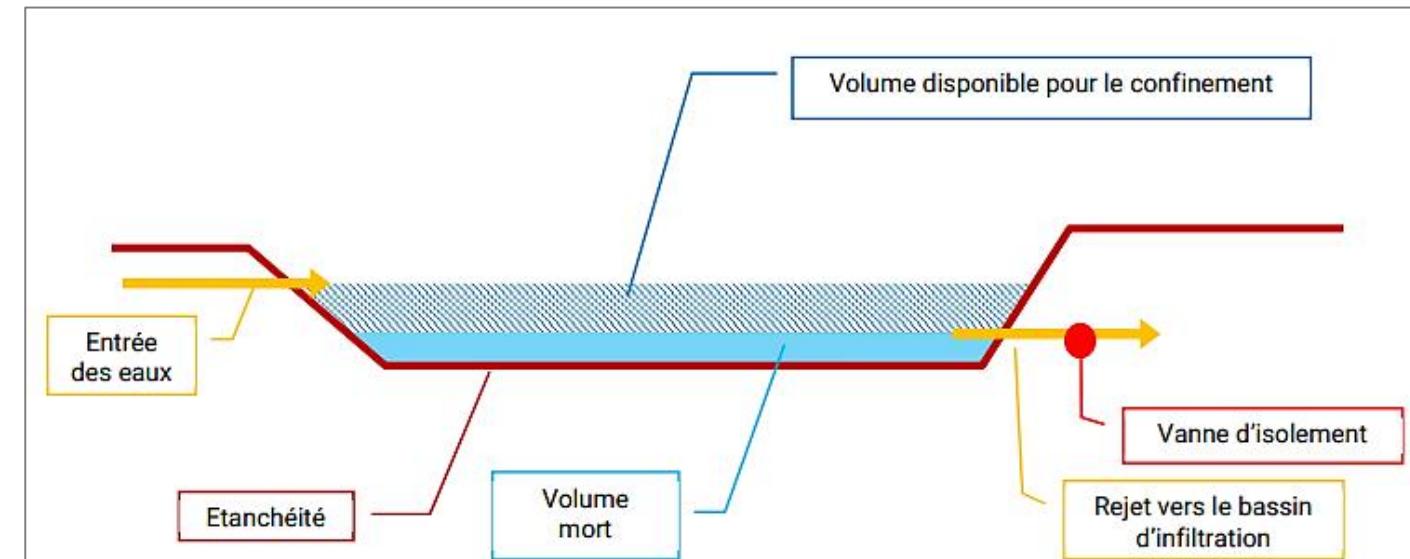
Coupe type d'un bassin étanche avec volume mort
